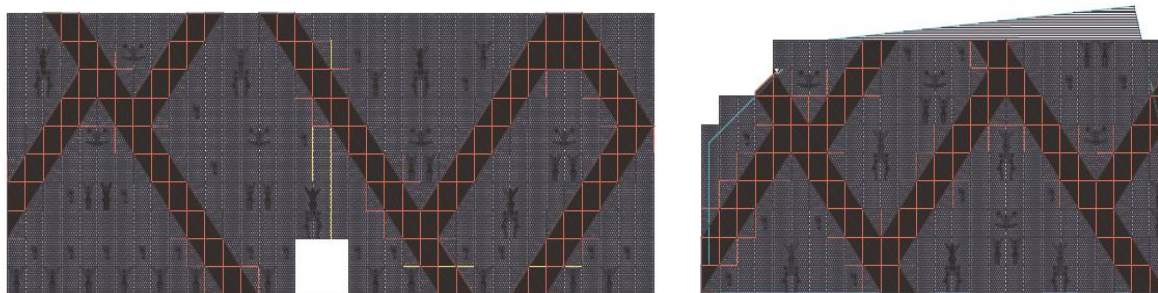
Microperforado de fachadas, lamina metálica. Elaboración propia.
